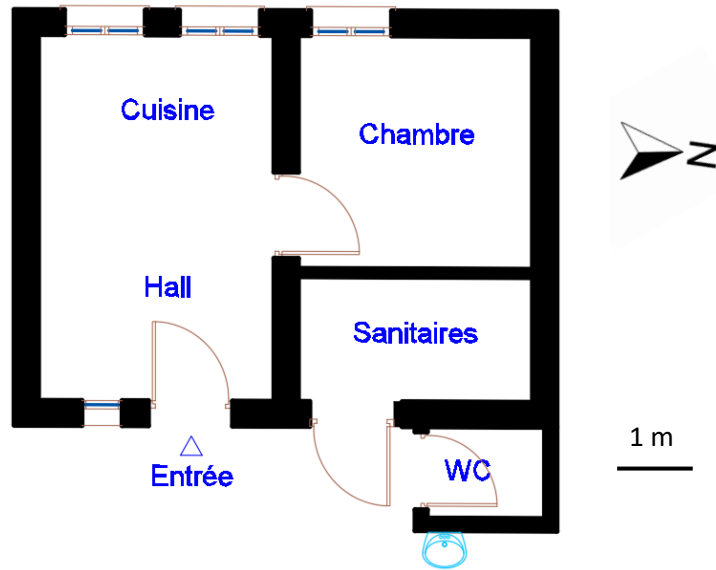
Plan de la maison Tighilit Source : auteur, 2023 ; traité par Autocad
